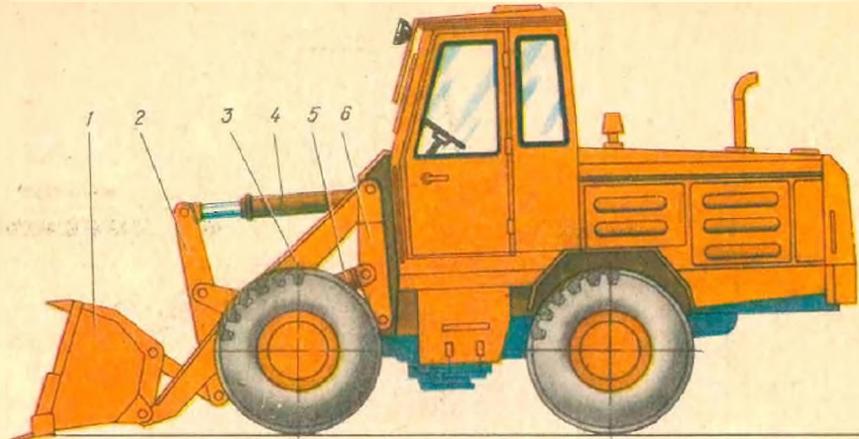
Однокошковый фронтальный пневмоколесный погрузчик ГО-6А
